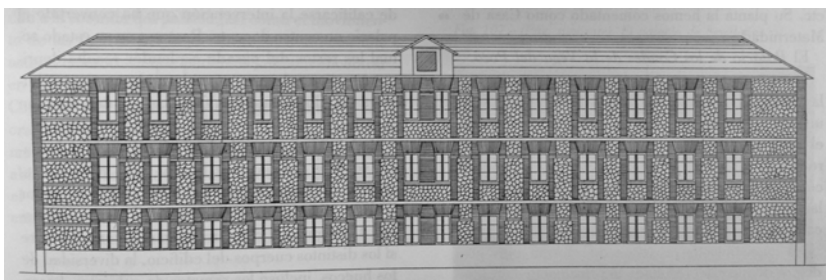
Edificio de Viviendas para guardias. Alzado posterior. 1909. Arquitecto: Ramón Benito Cura. AHMG
